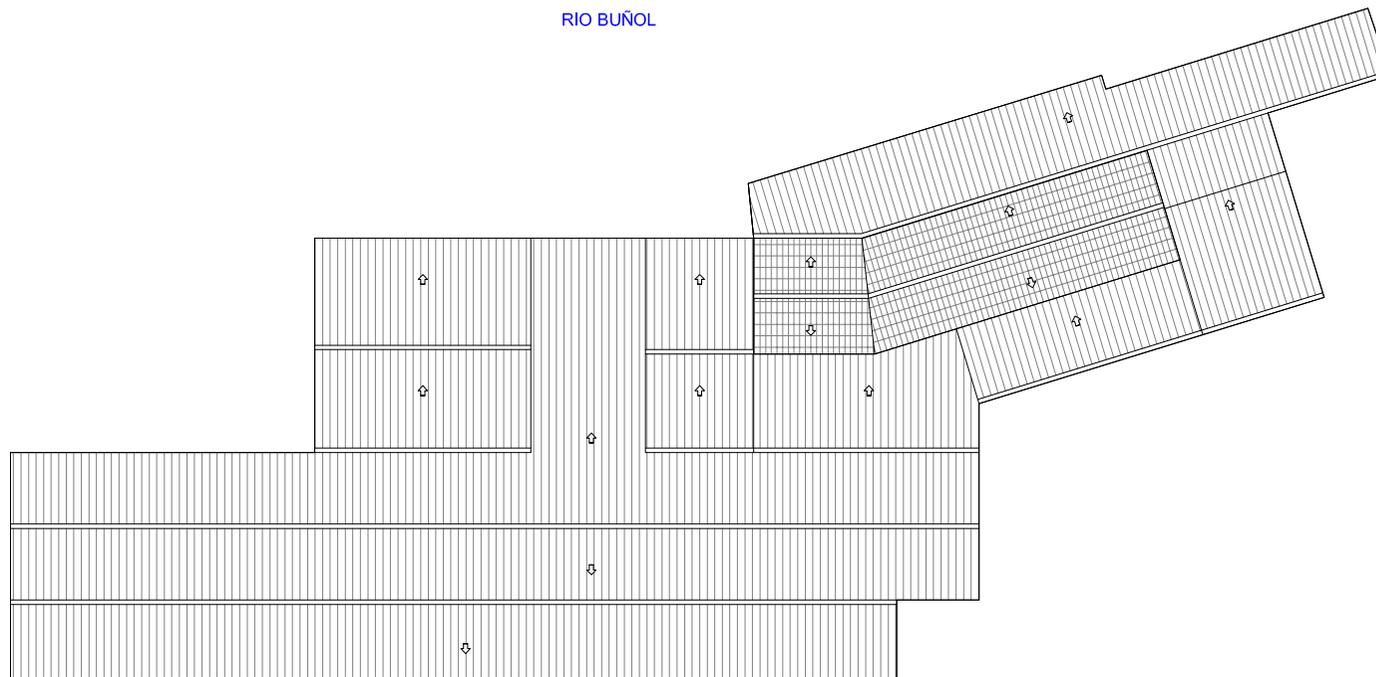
FOTO ESTADO ACTUALESQUEMA DE PLANTA
